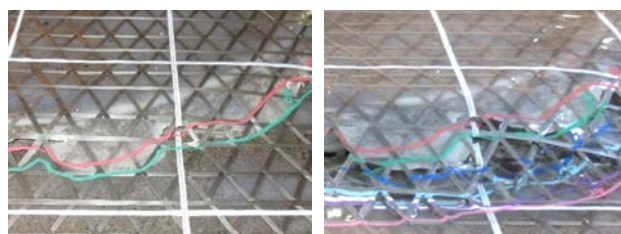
はく離状況 (左:段階 2, 右:段階 3)
